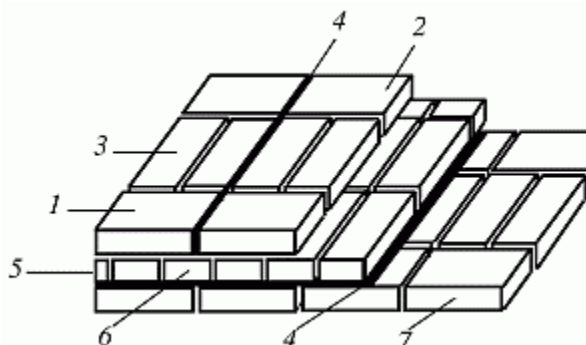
Элементы каменной кладки: 1 – наружная верста; 2 – внутренняя верста; 3 – забутка; 4 – горизонтальный и вертикальный швы; 5 – фасад; 6 – тычковый ряд; 7 – ложковый ряд
